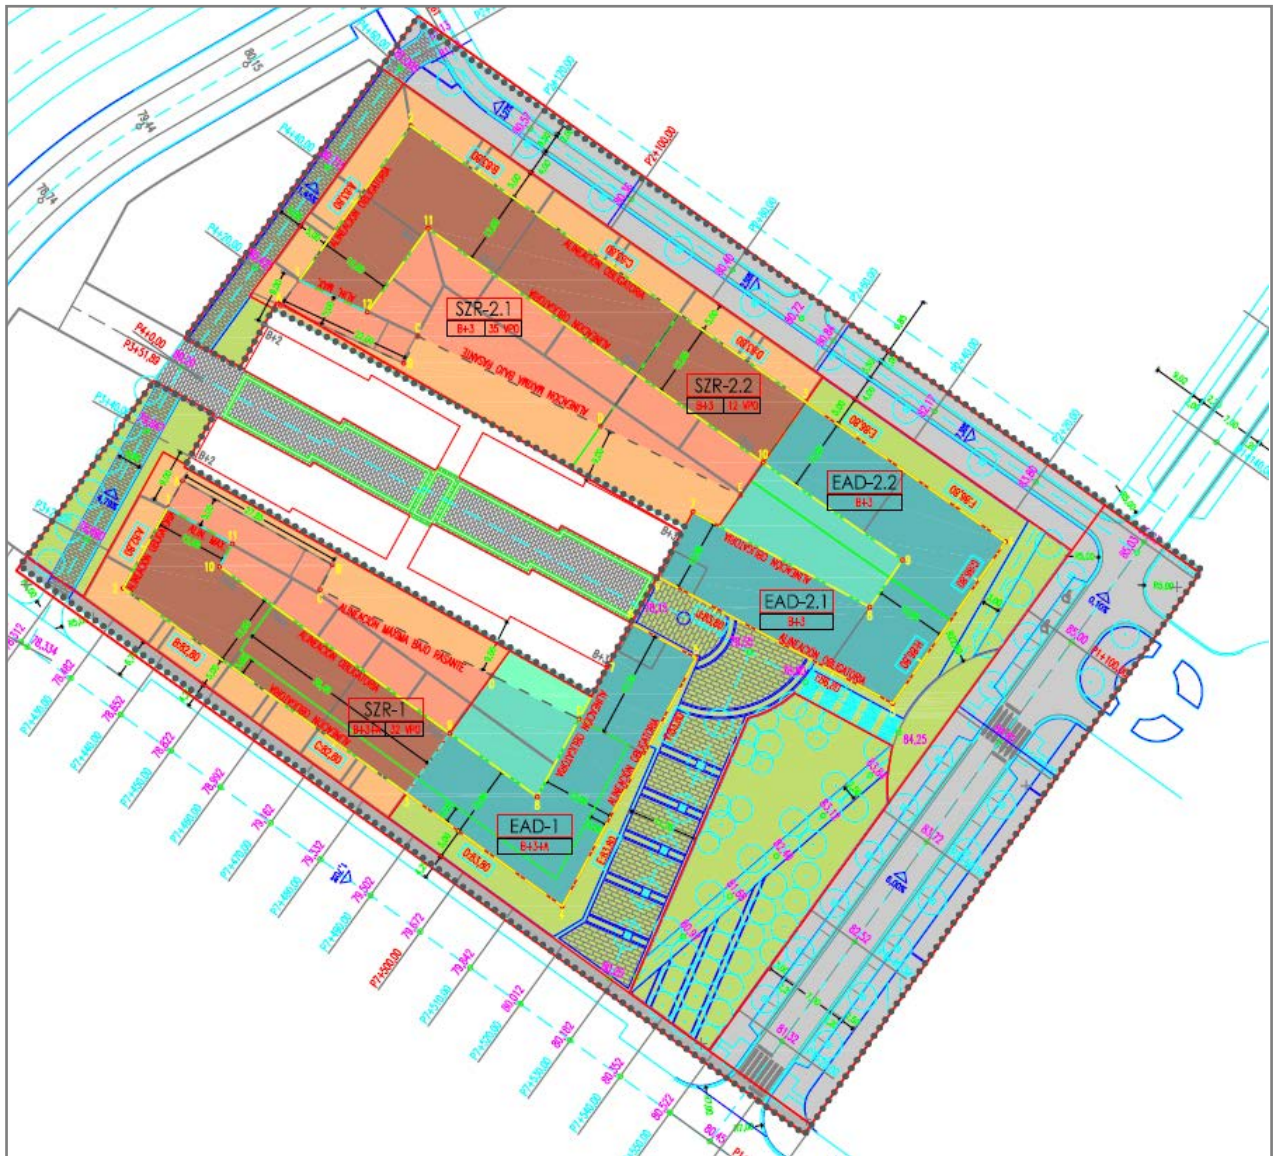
I: Alternativa 0 (Plan Especial aprobado)
